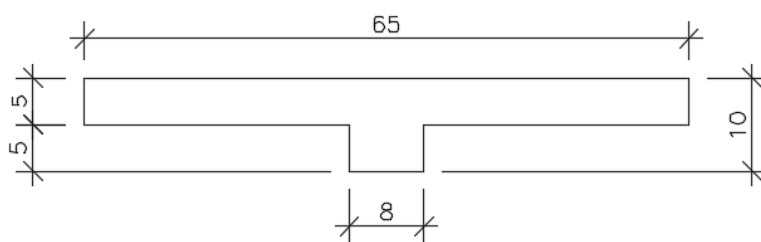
SEÇÃO 1 LAJE NERVURADA BIDIRECIONAL
